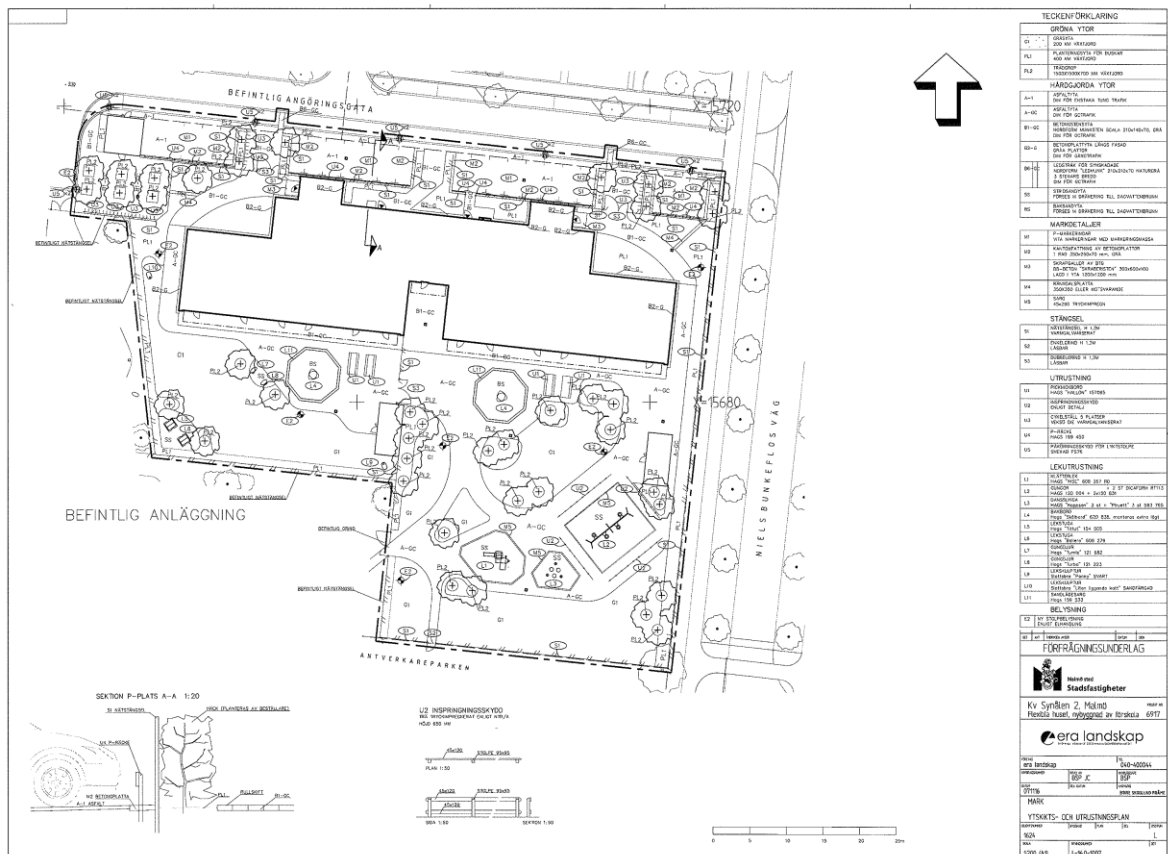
³² Situationsplan för byggnadskroppens placering på tomten.
